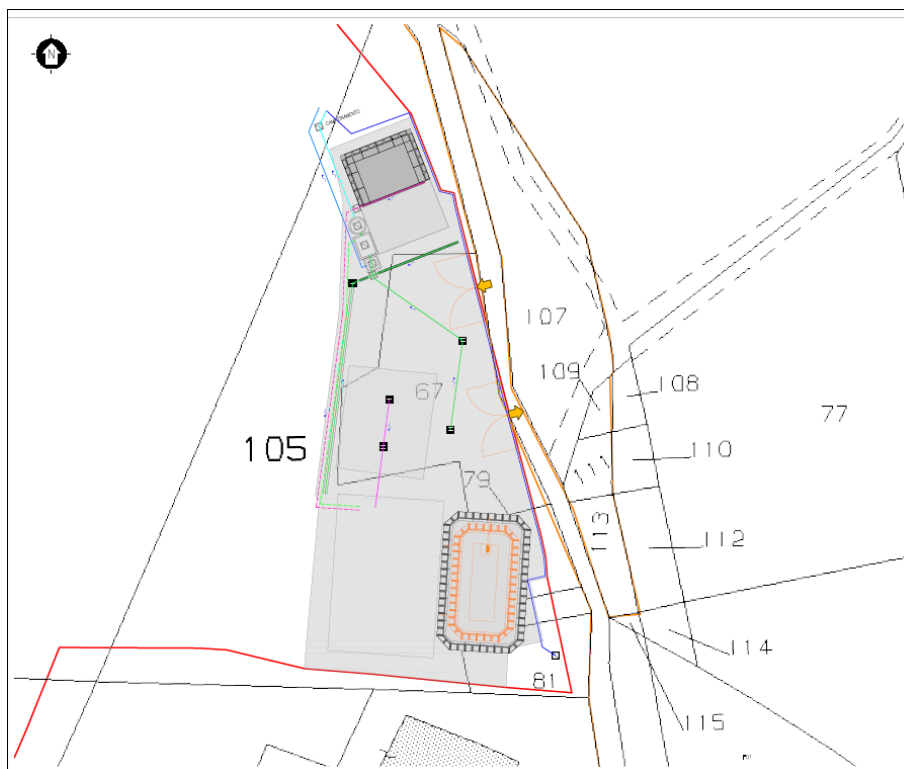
Stralcio elaborato grafico 2582_3937_R06_A45_PDC_T06_Rev0 - Planimetria su base catastale - Area servizi
